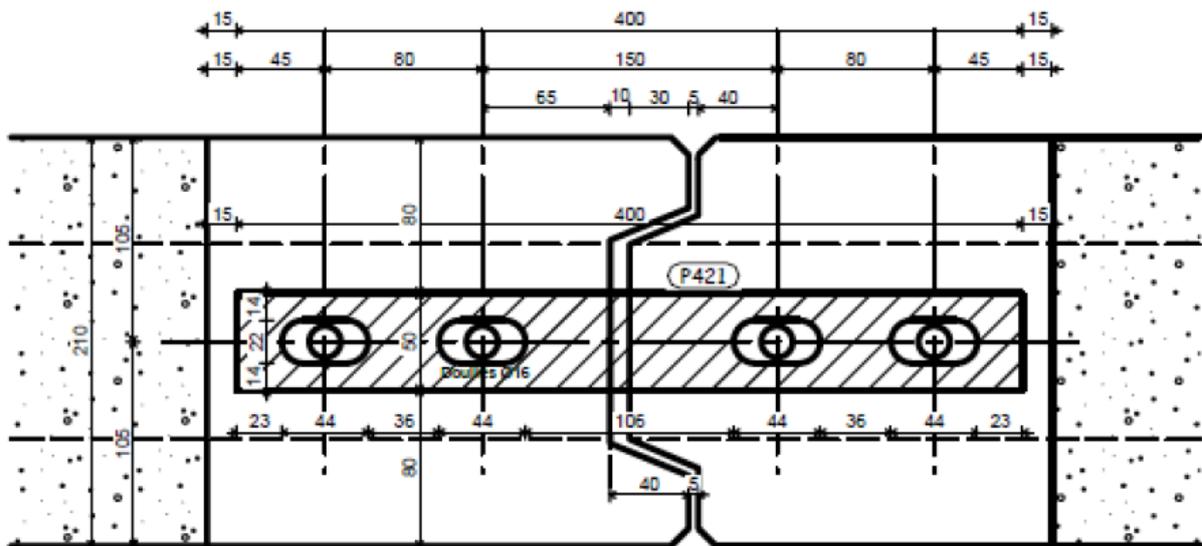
Panneaux sandwichs de façade posés sur plots (type germoir) – fixation mécanique entre panneaux juxtaposés
